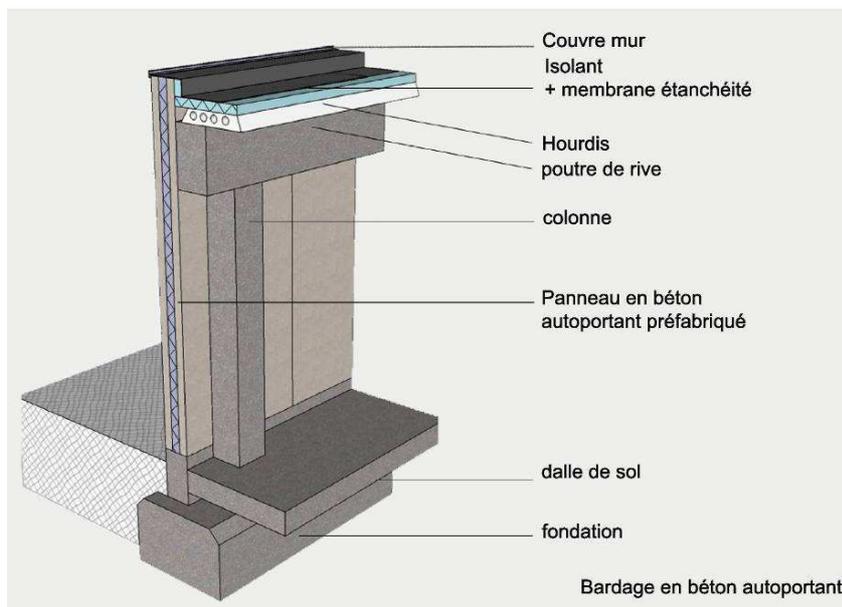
Coupe verticale dans une façade en panneaux sandwichs en béton de type autoportants
